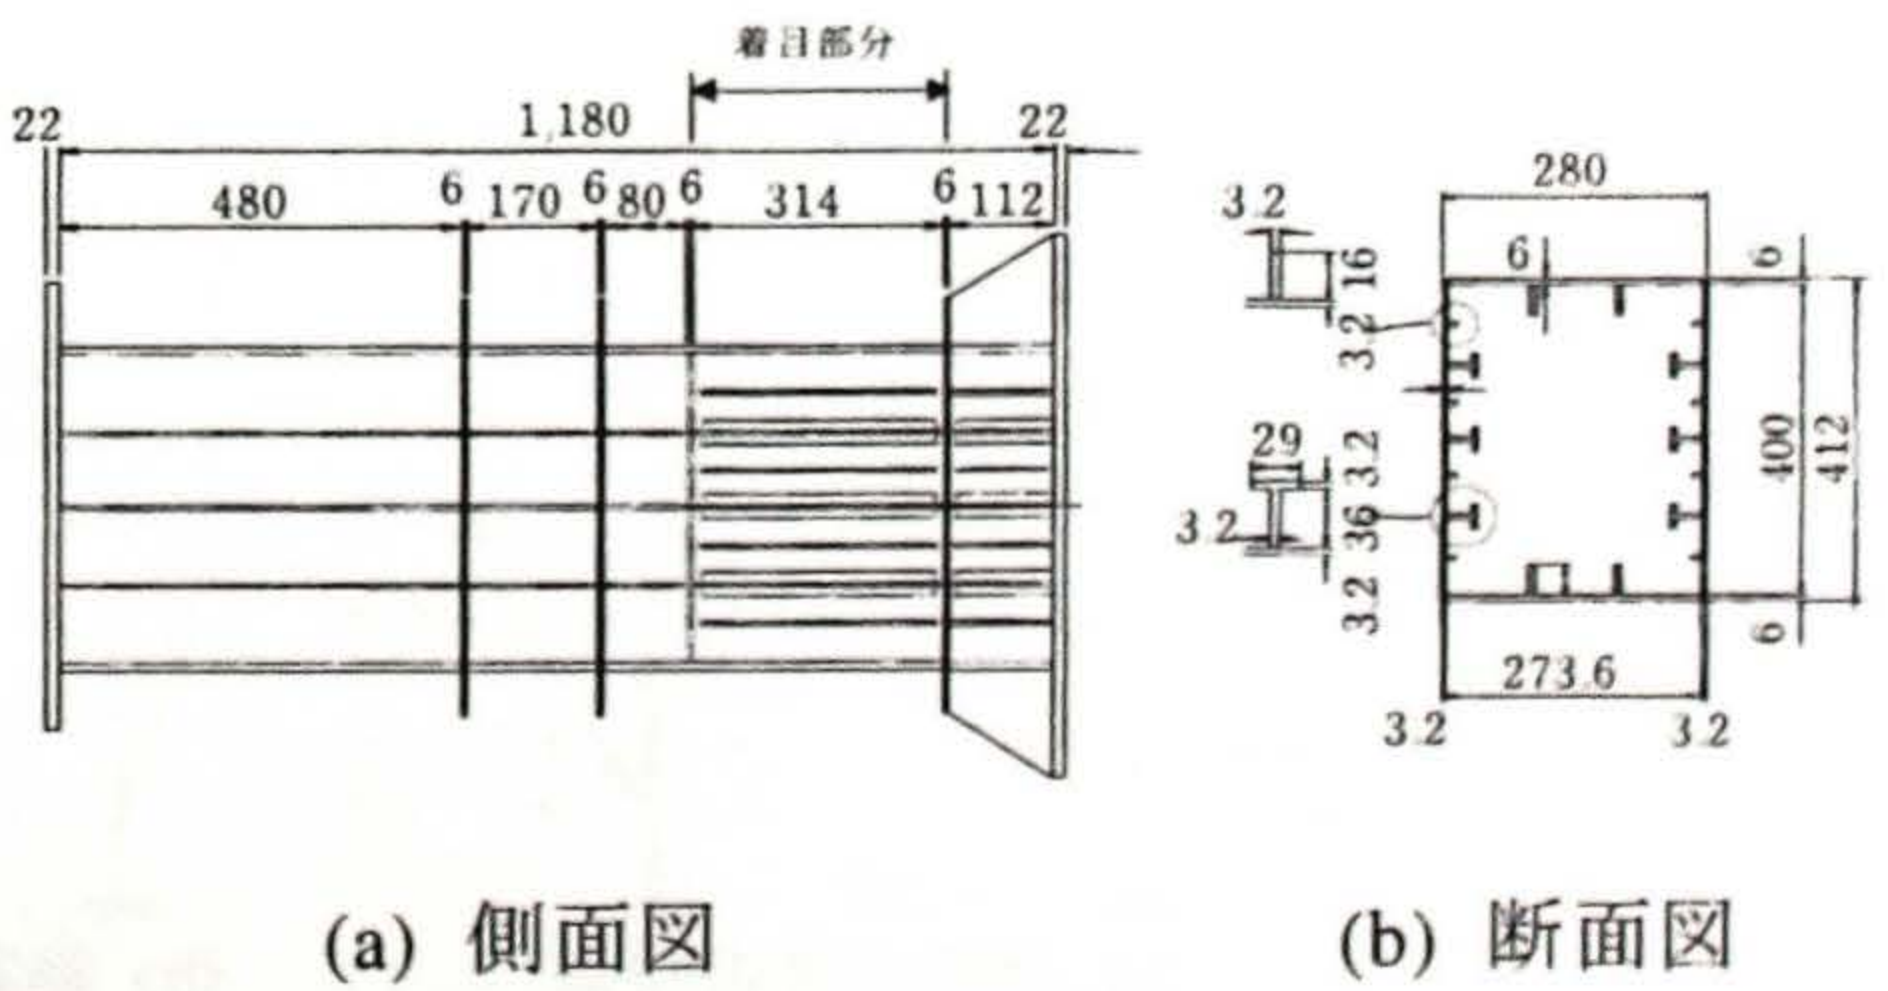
13 実験供試体 CER-5 および HER-2 (寸法単位：mm)
